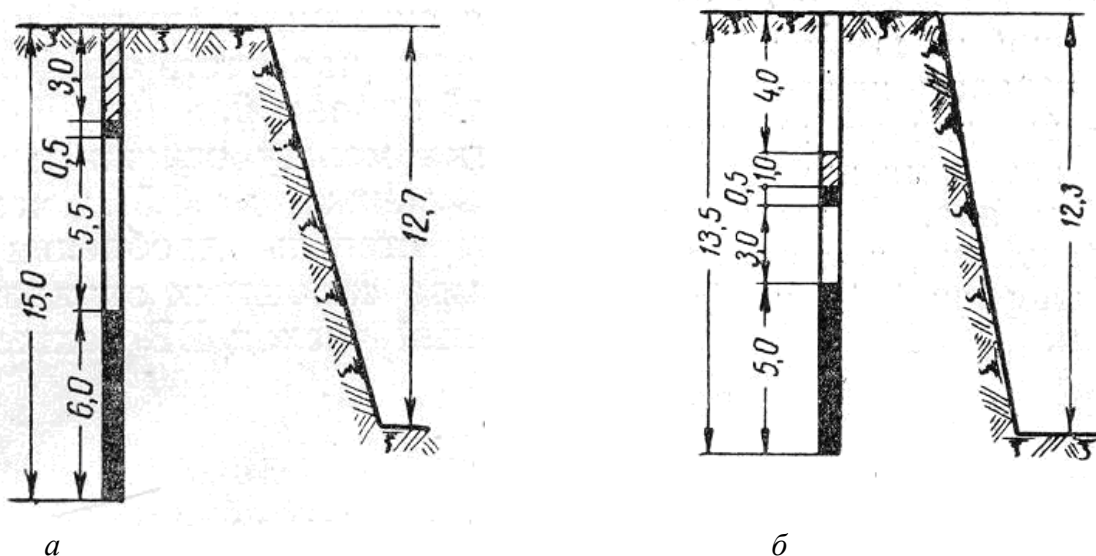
Конструкции зарядов с воздушными промежутками под забойкой
